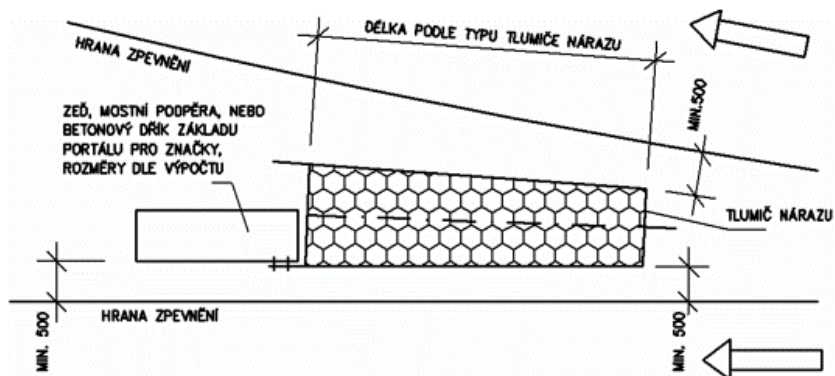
Příklad půdorysného umístění tlumiče nárazu. [4]
